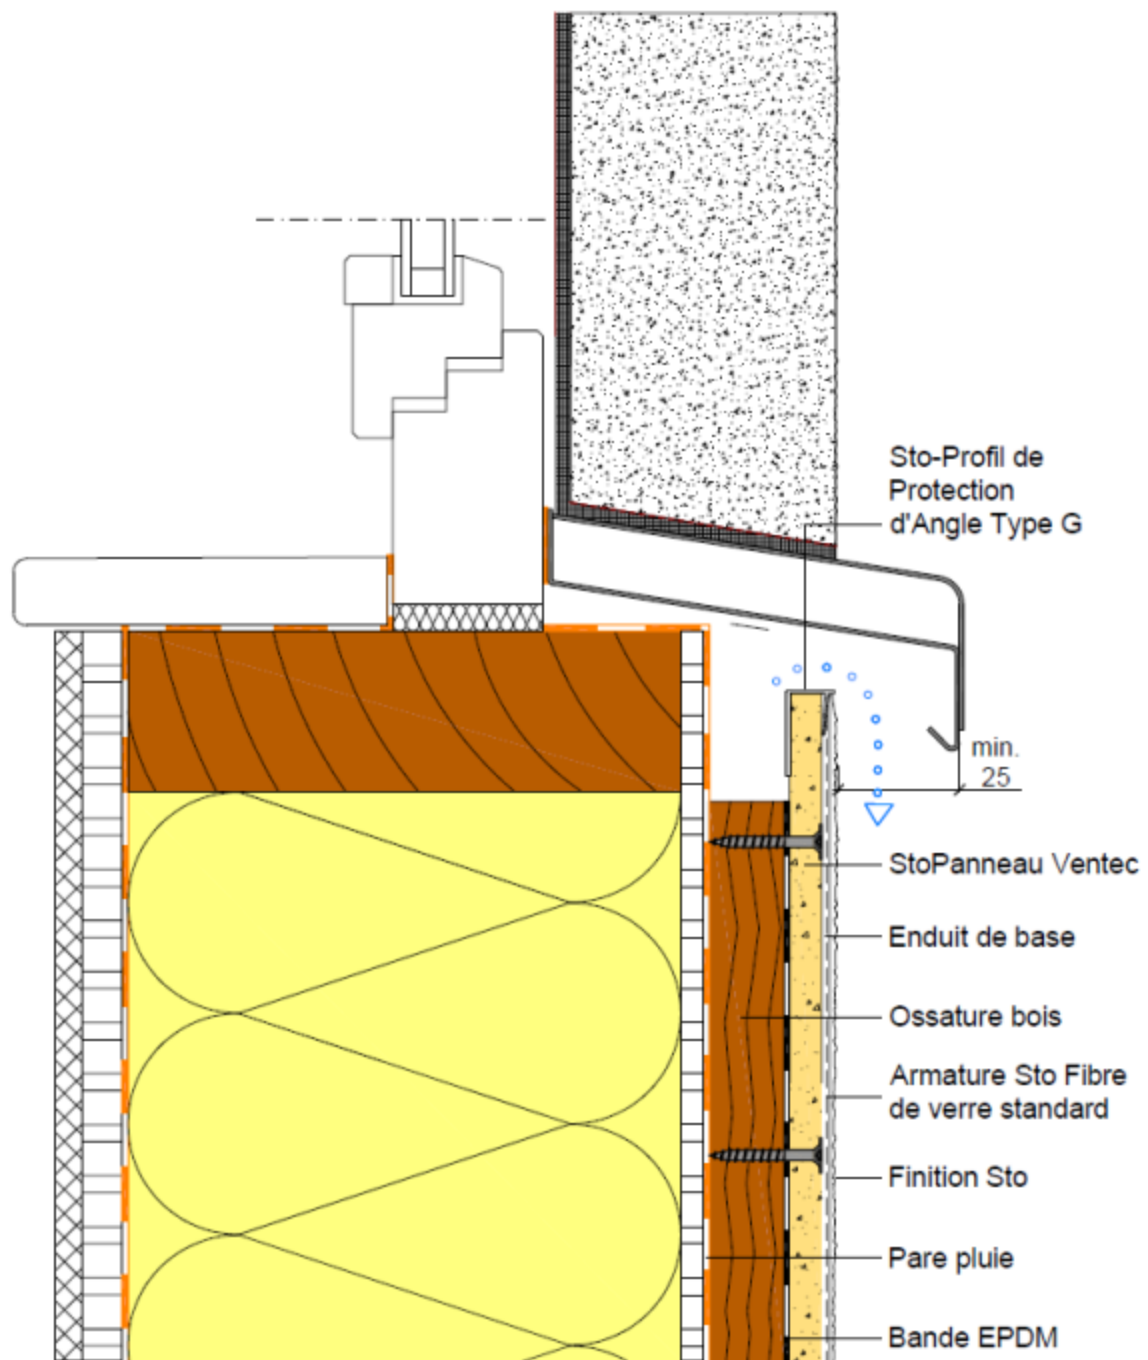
Coupe verticale - Menuiserie posée en tunnel - Traitement de linteau non isolé en retour de parement - Ossatures bois sur COB
